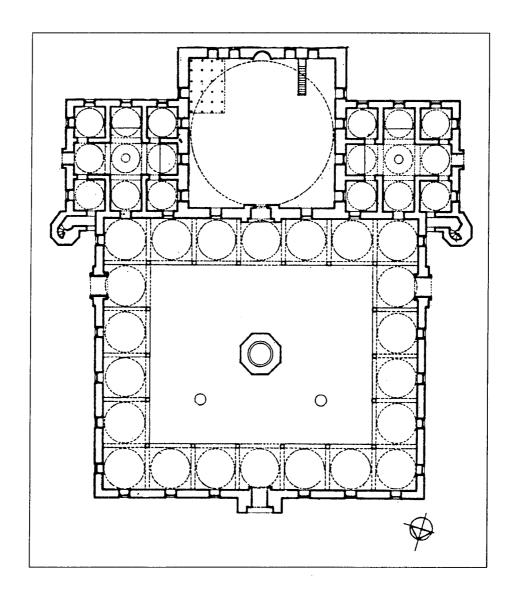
مسقط أفقي وقطاع لمسجد مراد الثاني في اسكوب (عن : ايفردى)
